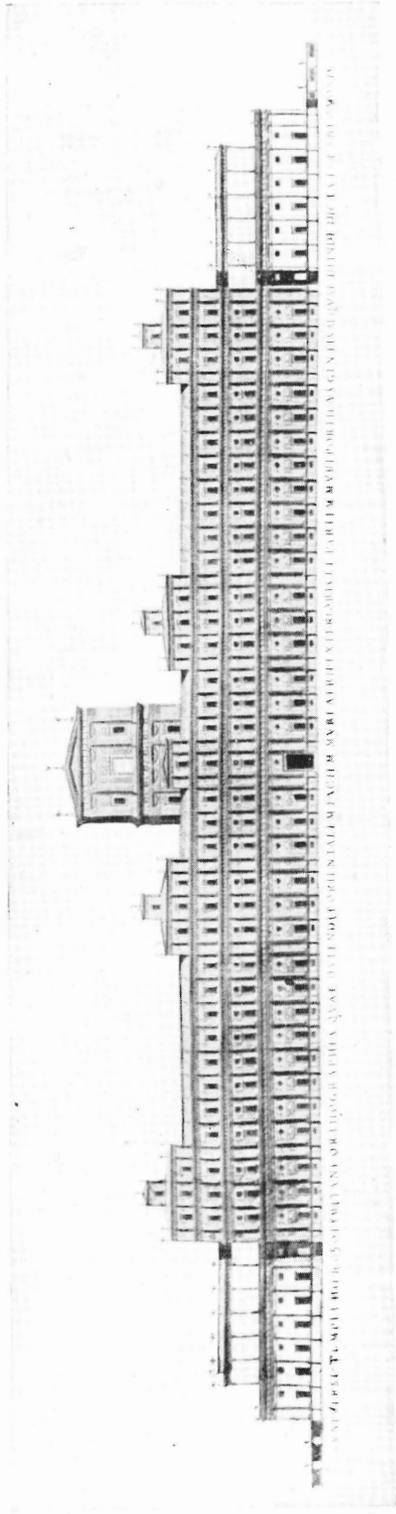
VILLALPANDO: Alzada de la fachada oriental del templo.
